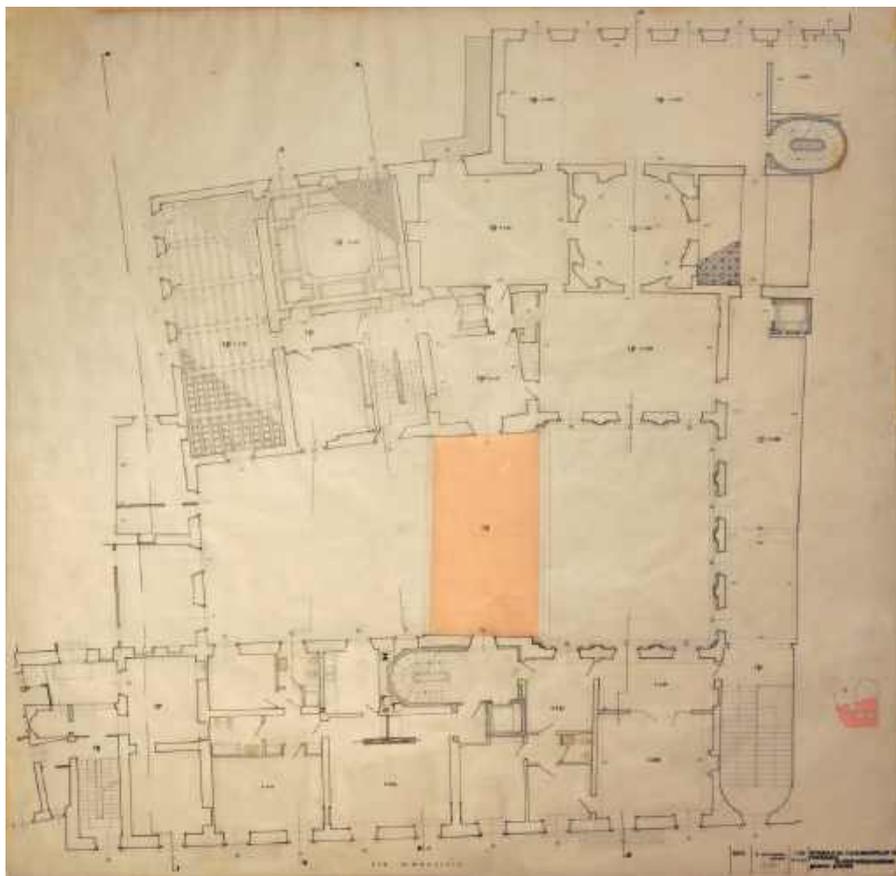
Stabile su via San Maurizio n. 19, corpo nord, pianta piano primo, progetto di restauro e adattamento a banca; tavola su lucido
